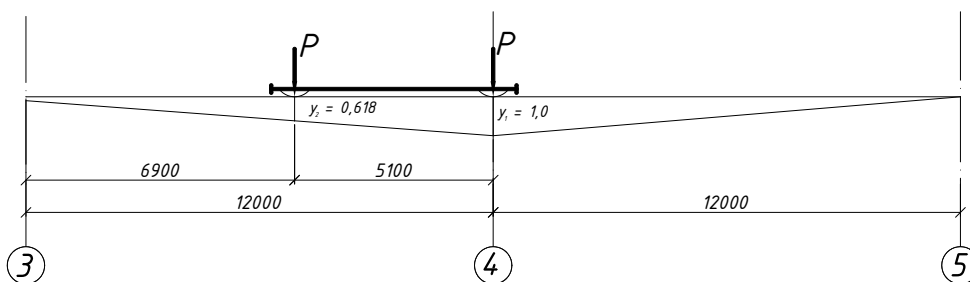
Загрузка колонны типовой (для расчетной рамы) оси одним краном
